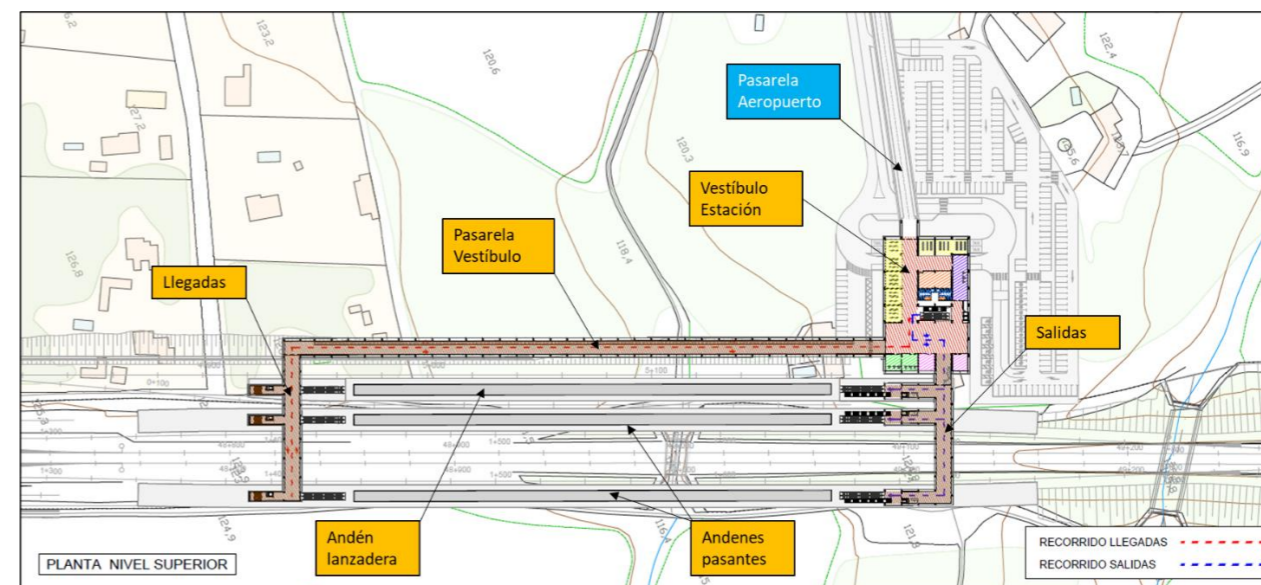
Planta de vestíbulo y pasarelas de conexión entre andenes y aeropuerto
